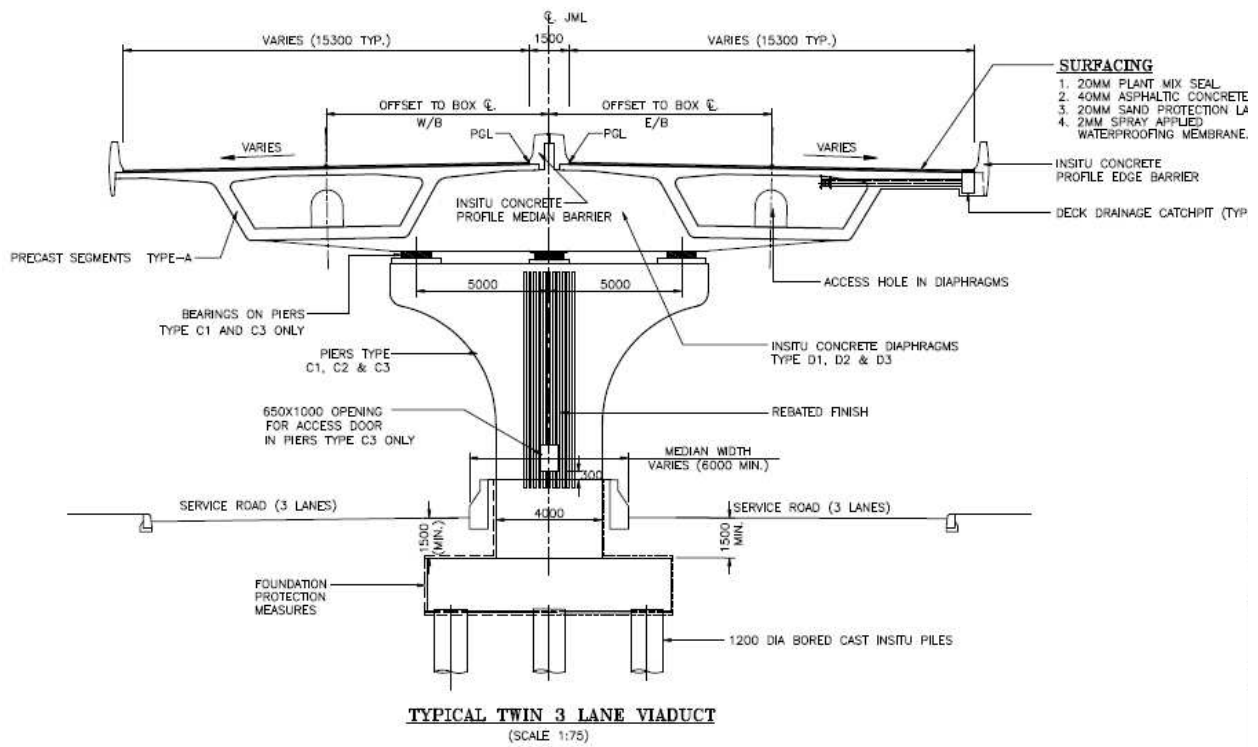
Pila tipica e diaframma “testa-pila” su appoggi
